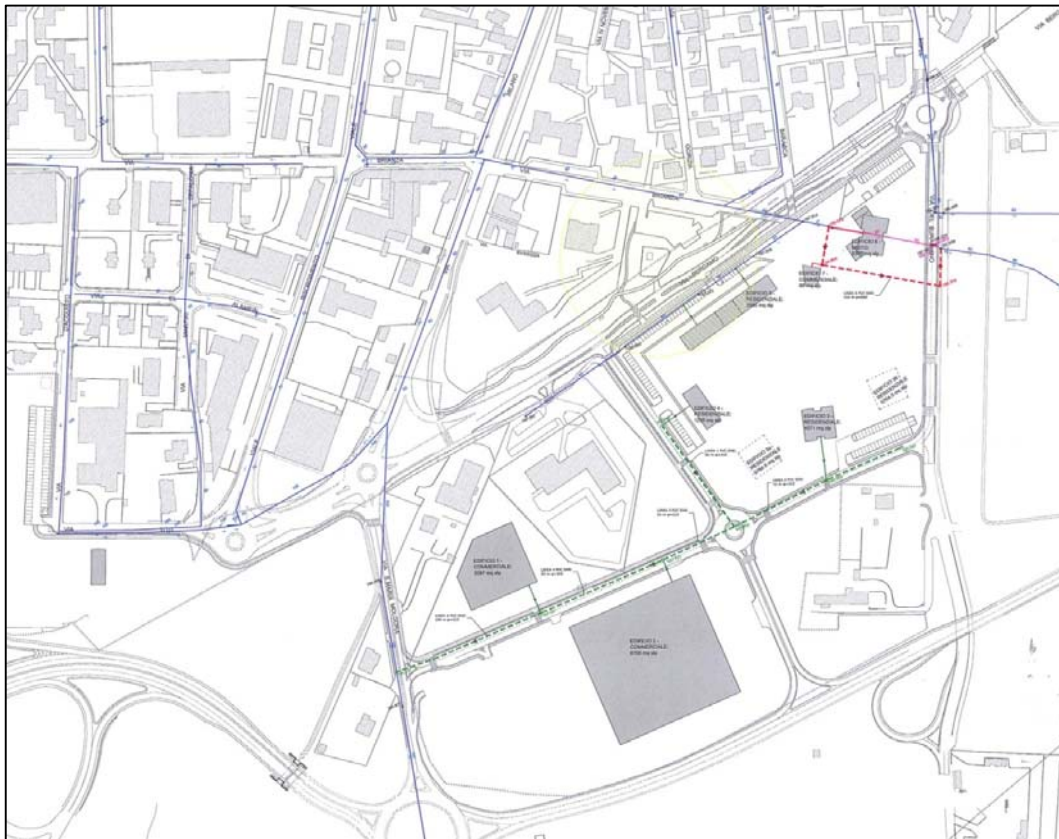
Planimetria generale della rete fognaria acque nere in progetto
